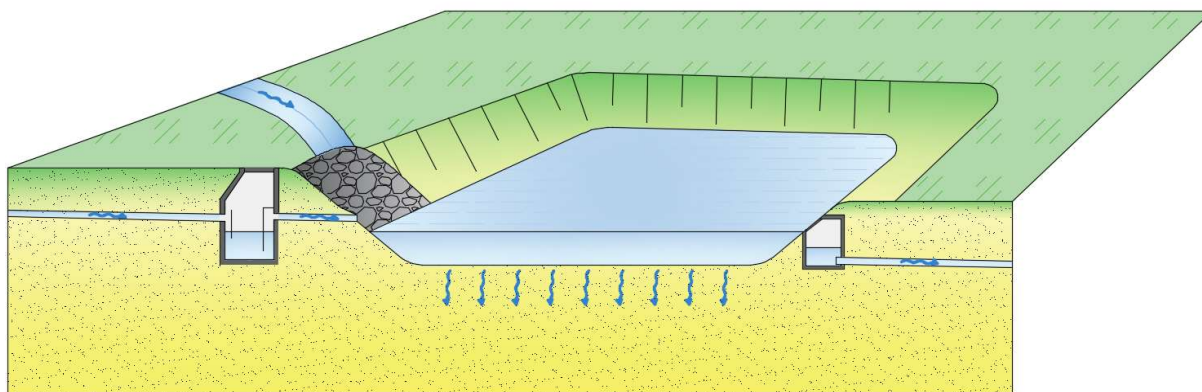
Schematy przykładowych urządzeń do rozproszonej infiltracji
